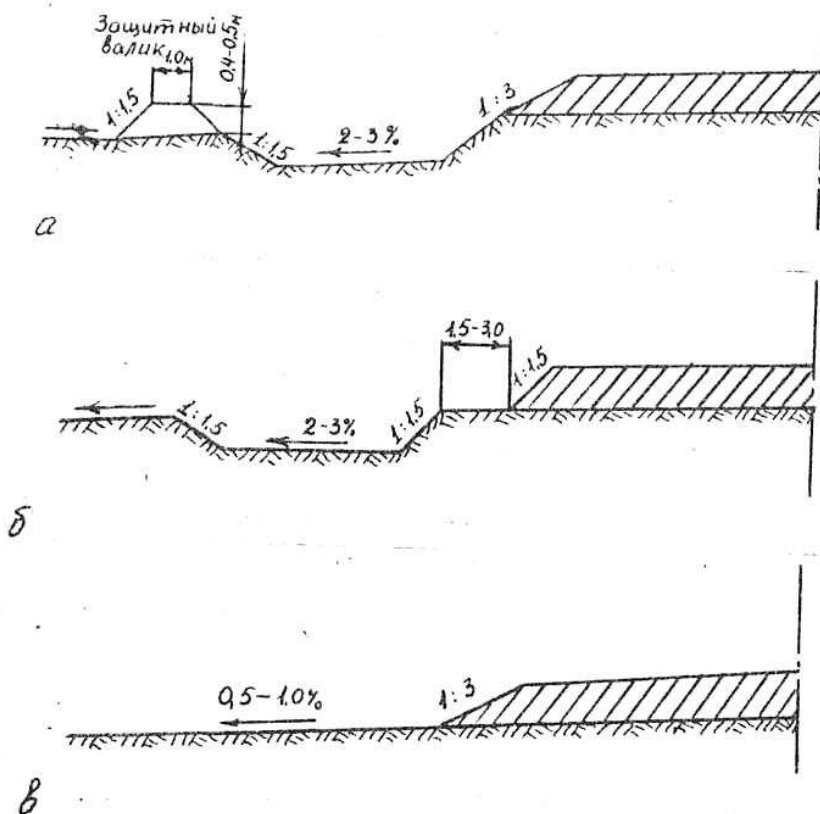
Поперечні профілі земляного полотна на засолених ґрунтах
